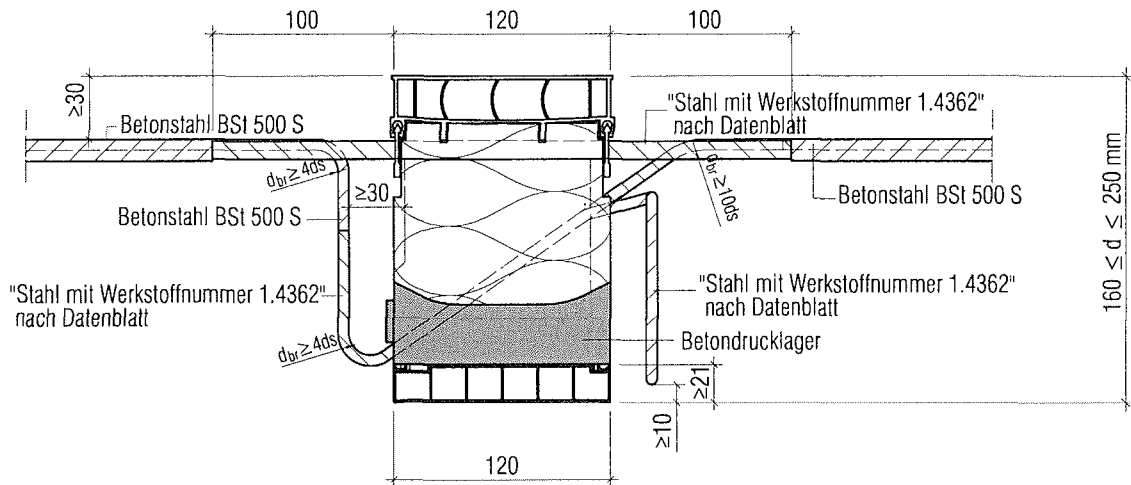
Schöck Isokorb Typ K mit Druck- Querkraft Kombination, integrierter Aufhängebewehrung und Drucklageraufhängung
